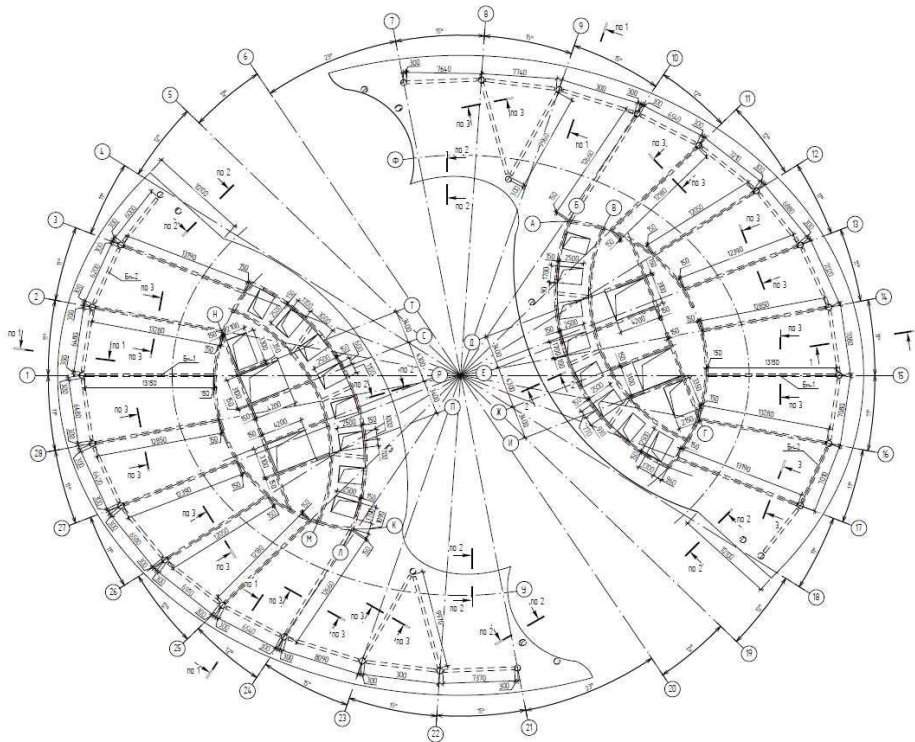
Опалубне креслення монолітної плити перекриття
